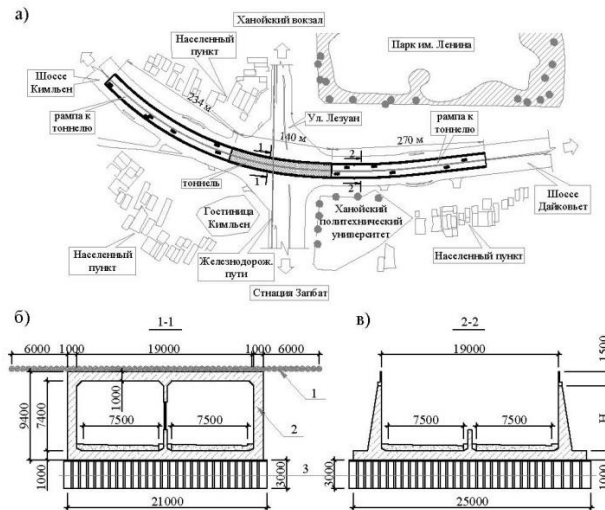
а) – План-схема транспортной развязки Кимльен – Лезуан; б) – поперечное сечение тоннеля Кимльен; в) – поперечное сечение рампы; 1 – трубы защитного экрана; 2 – обделка тоннеля; 3 – грунтоцементные колонны.
